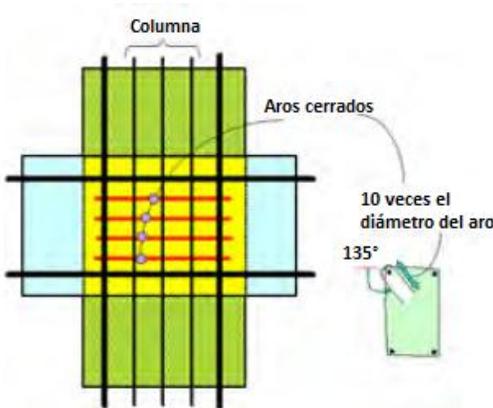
Deben proveerse estribos cerrados con poco espaciado entre sí en la zona de la unión viga-columna (fuente: Murty 2005).
